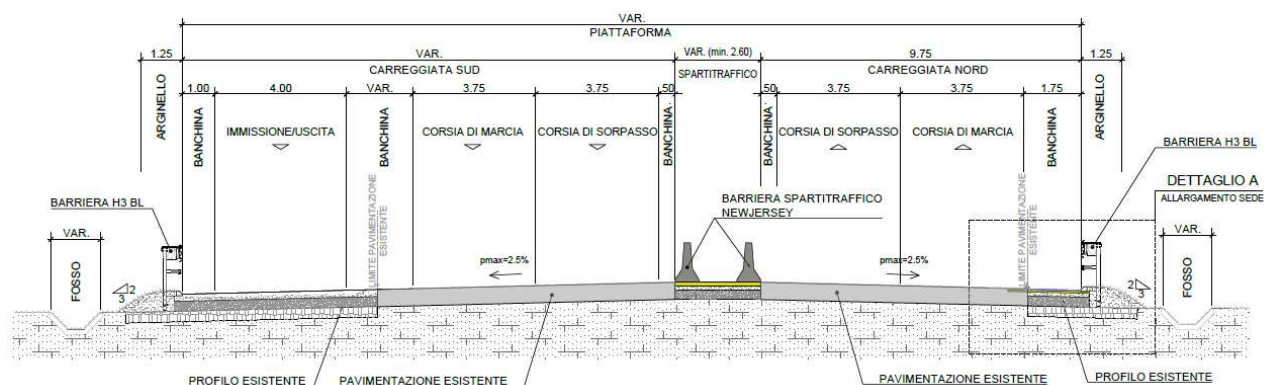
Sezione tipologica n.8 in rettilo a raso con singolo ramo in affiancamento
